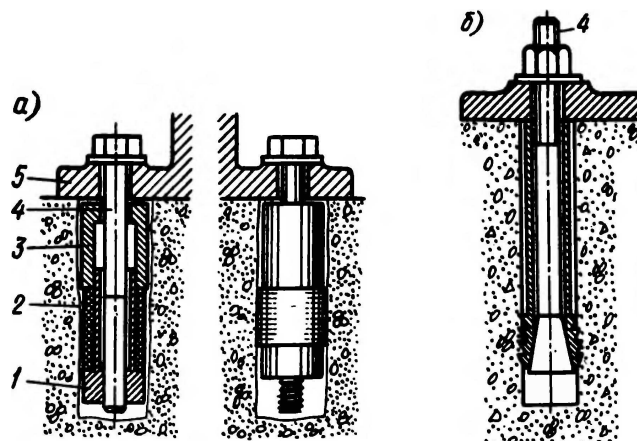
Схеми кріплення обладнання самоанкерувальними болтами:
